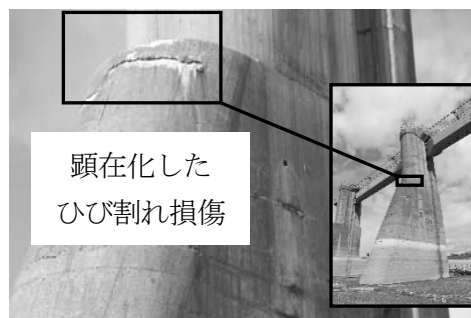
農業水利施設におけるひび割れ損傷の顕在化
